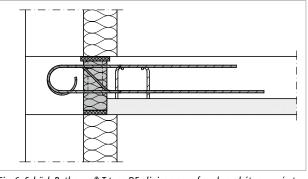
Schöck Rutherma® T type DF : liaison pour façade en béton armé et plancher constitué de prédalles
